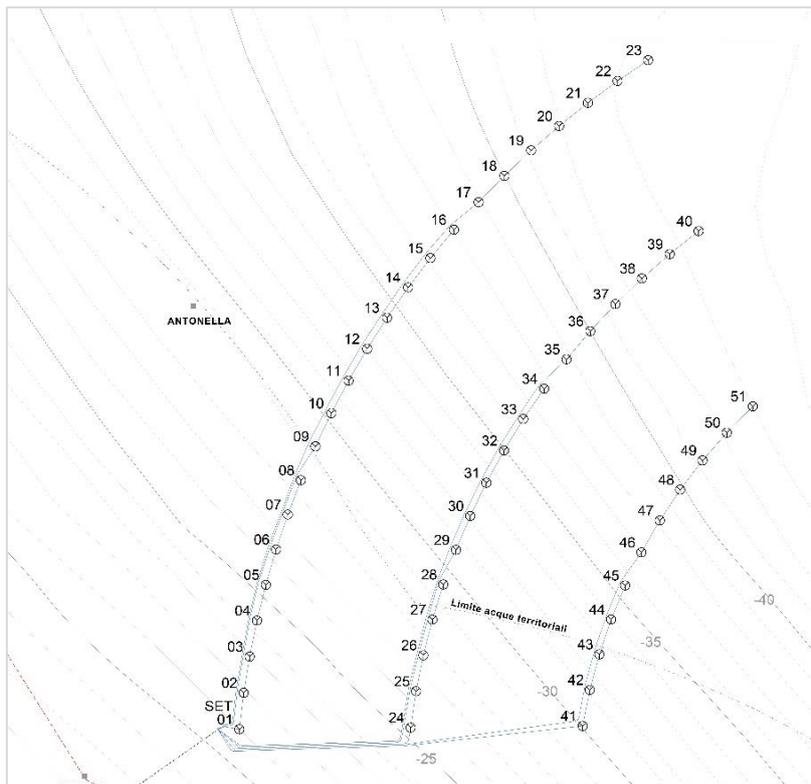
Distribuzione dei cavi del LAYOUT B di collegamento tra gli aerogeneratori e la Stazione in mare.
